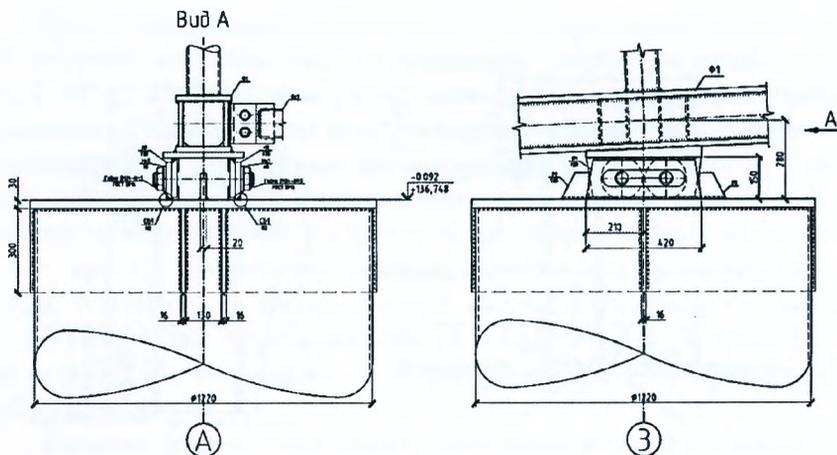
Узел опирания моста на сталежелезобетонные опоры
